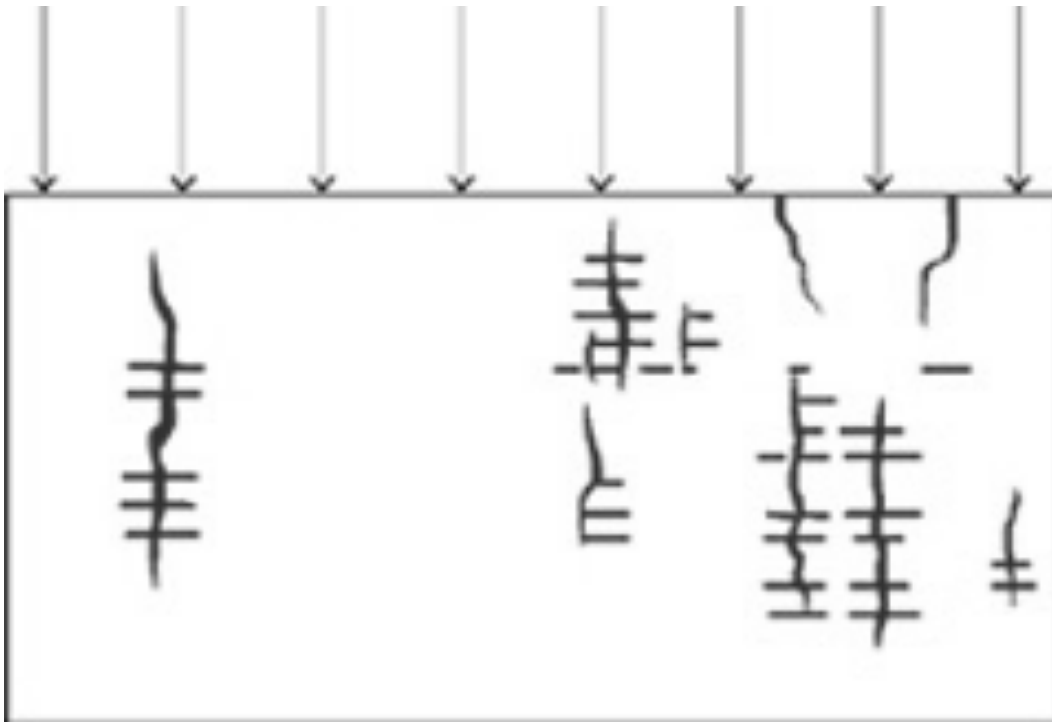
Fissuração típica da alvenaria causada por sobrecarga vertical (THOMAZ, 1989).
